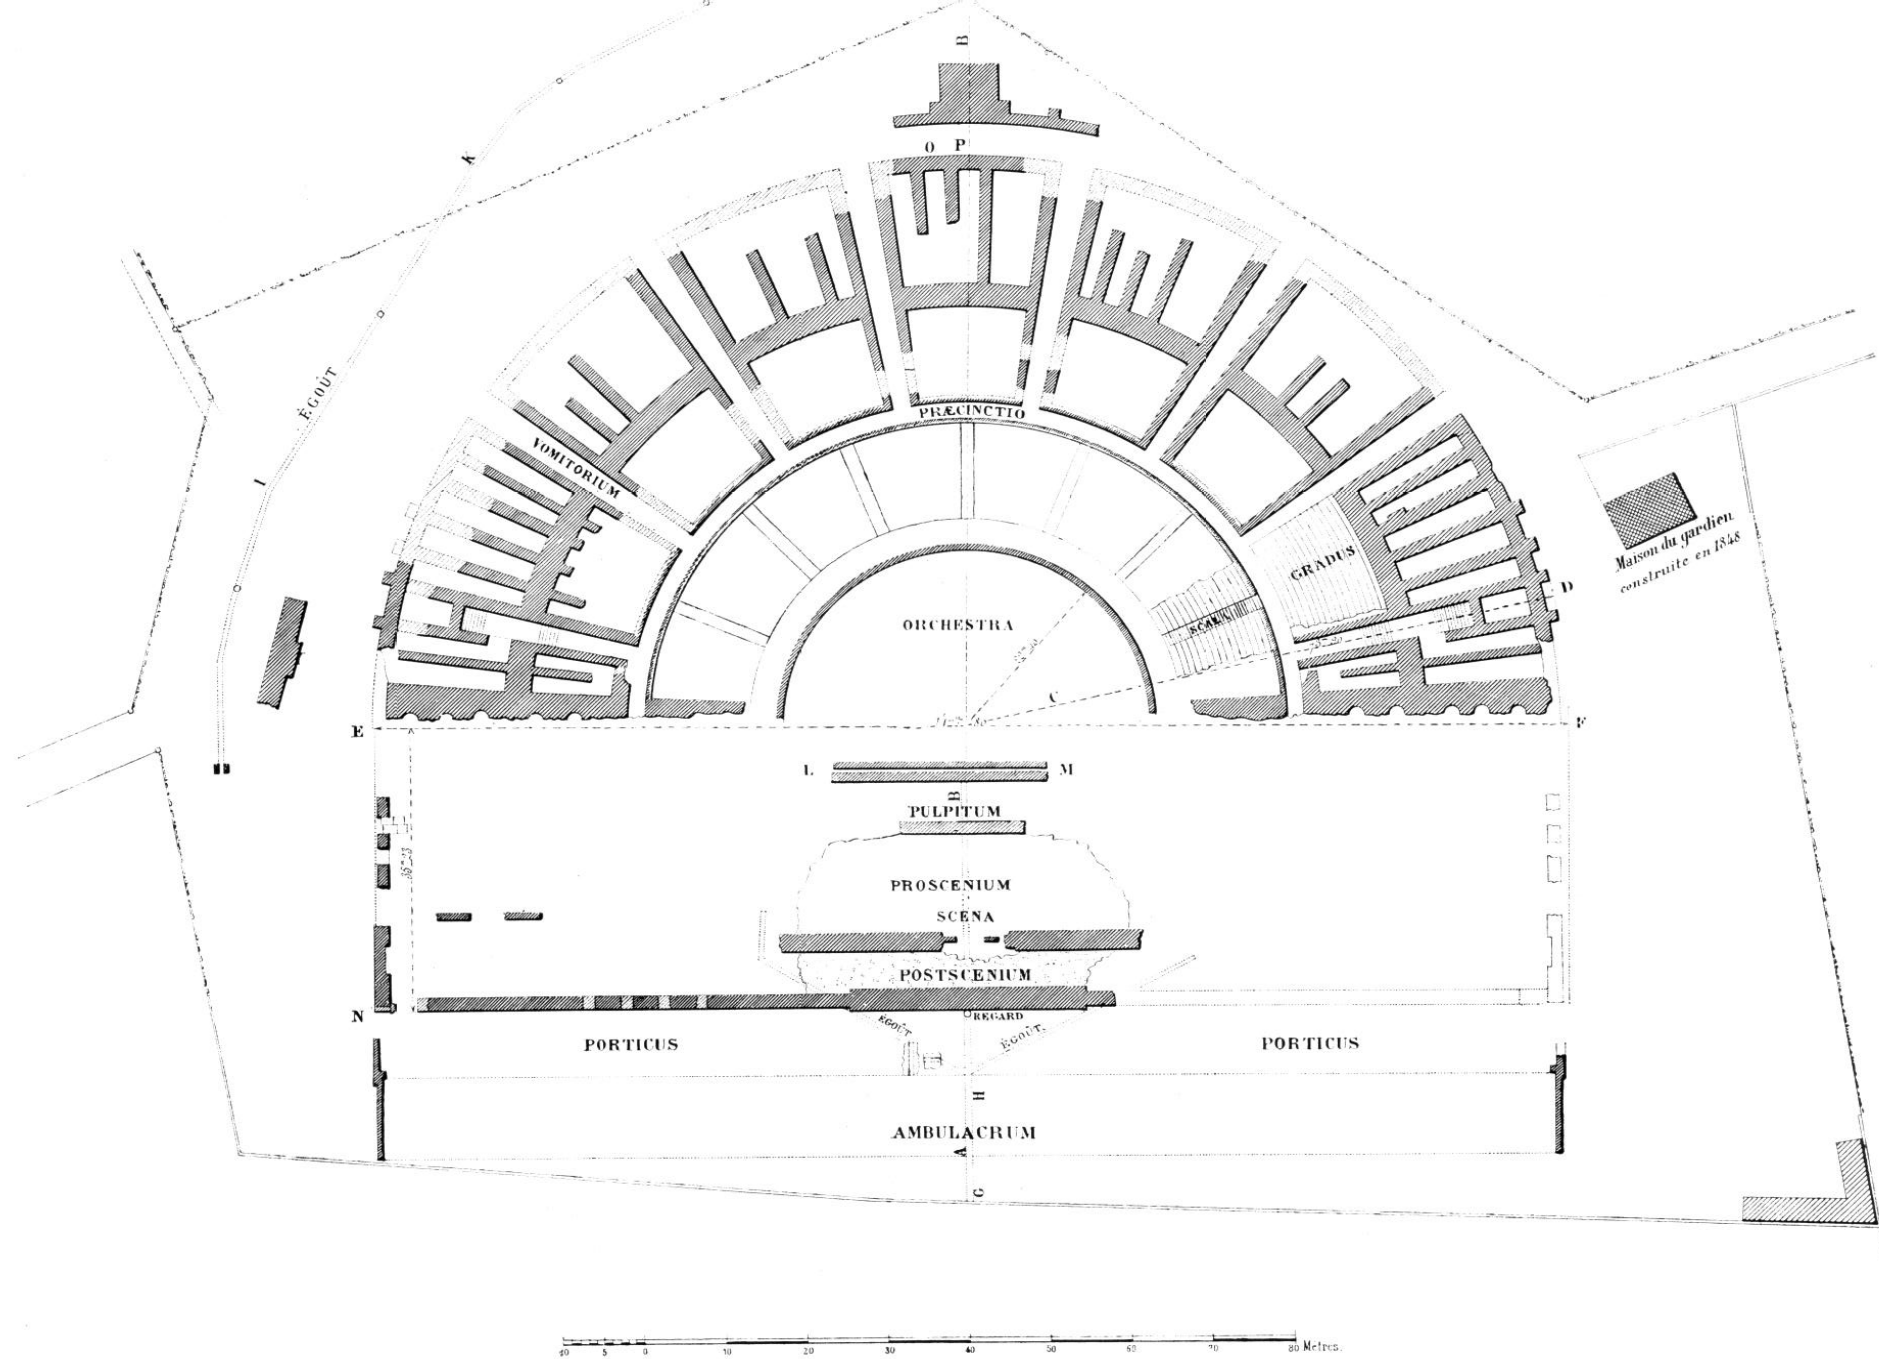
Planche XVIII de Roidot : plan du théâtre.
